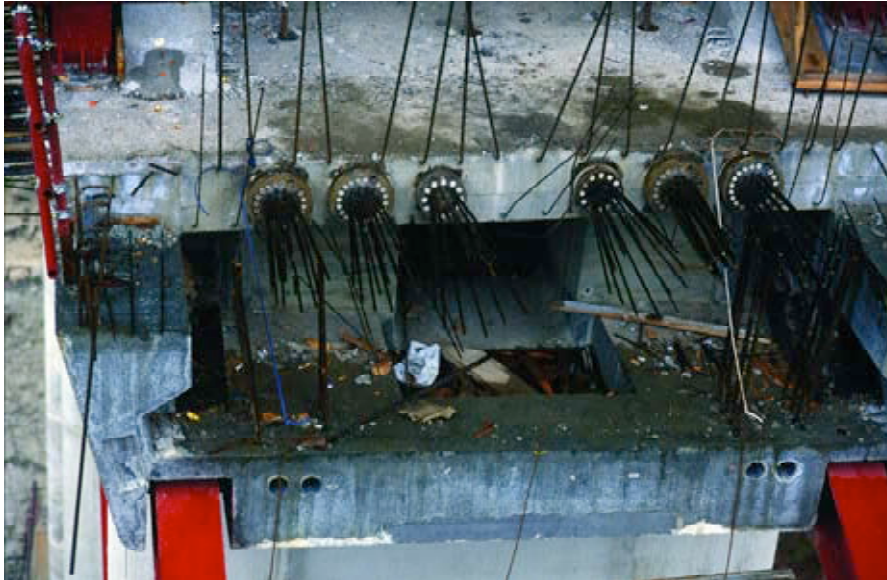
Vista frontal de viga. Se aprecian el pretensado superior y los taladros del pretensado inferior.
